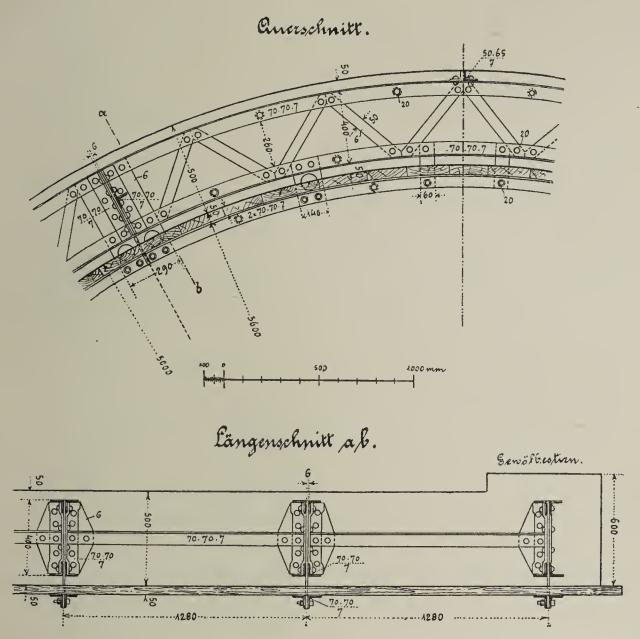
und 327. Verlängerung des Egydi=Tunnels; Detail des Gewölbes im Scheitel.
